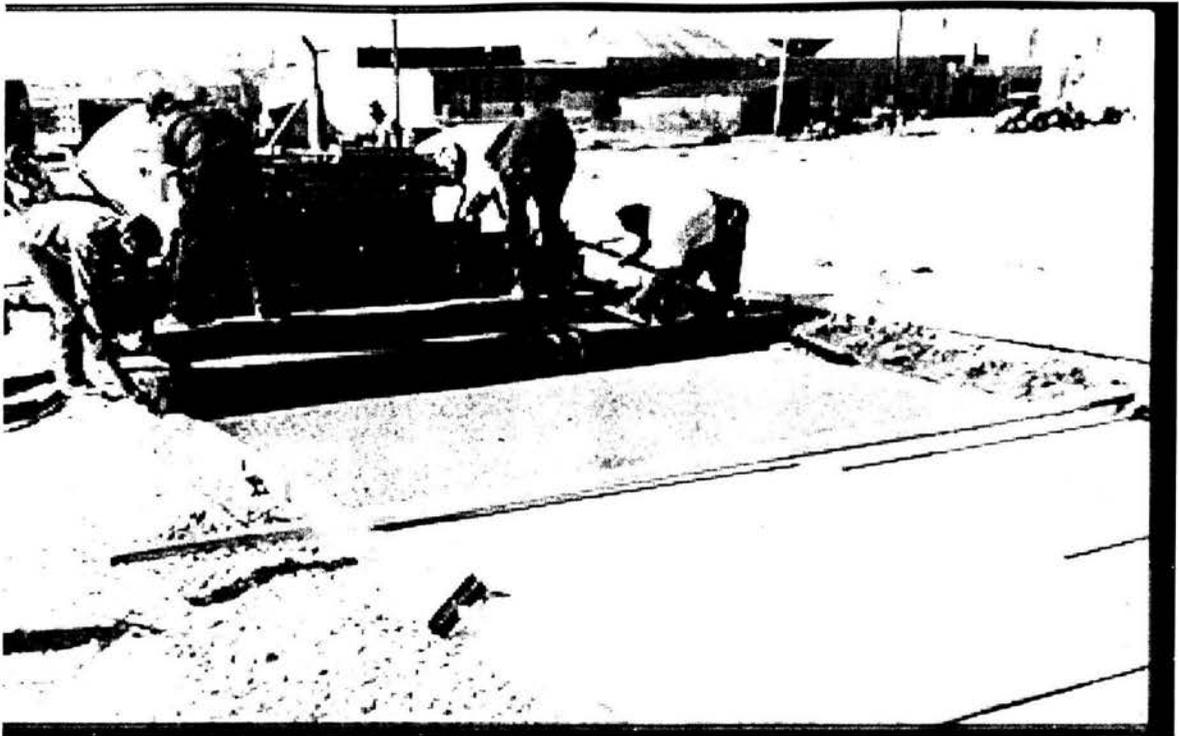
El ancho del pavimento será especificado por el ingeniero
